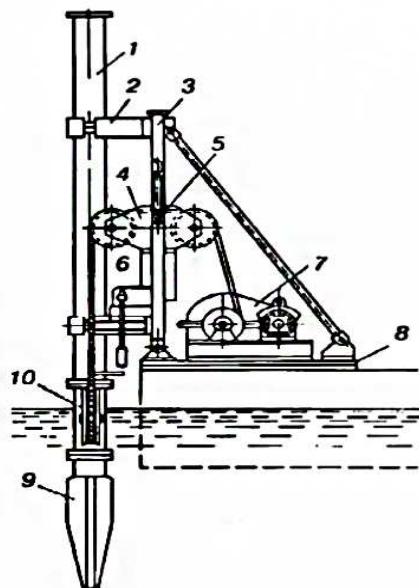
Шагающий свайных ход схема конструкции; 1 – свая; 2 – направляющие сваи; 3 – портал; 4 – двойной блок; 5 – ролик; 6 – выключатель; 7 – лебедка; 8 – рама; 9 – наконечник сваи; 10 – блок
